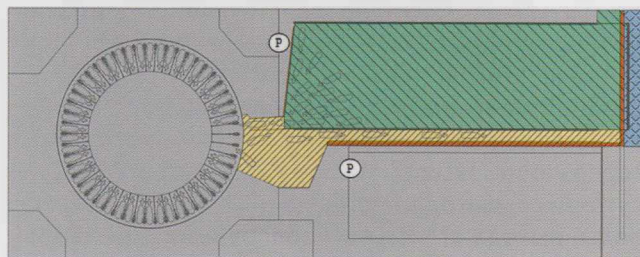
Схема расположения исследуемых зон преддоильных и последоильных площадок: — зона 1 (преддоильная площадка); — зона 2 (вход-выход коров на доильную установку и скотопрогон вдоль преддоильной площадки); — зона 3 (скотопрогон для прохода коров в коровник); — навозный канал; (Р) — точки подключения счетчиков расхода воды
